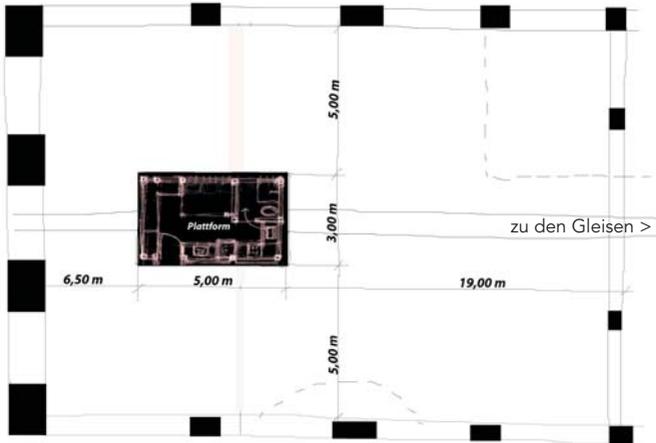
Skizze des Grundrisses der Bahnhofsvorhalle mit Lage der Plattform
